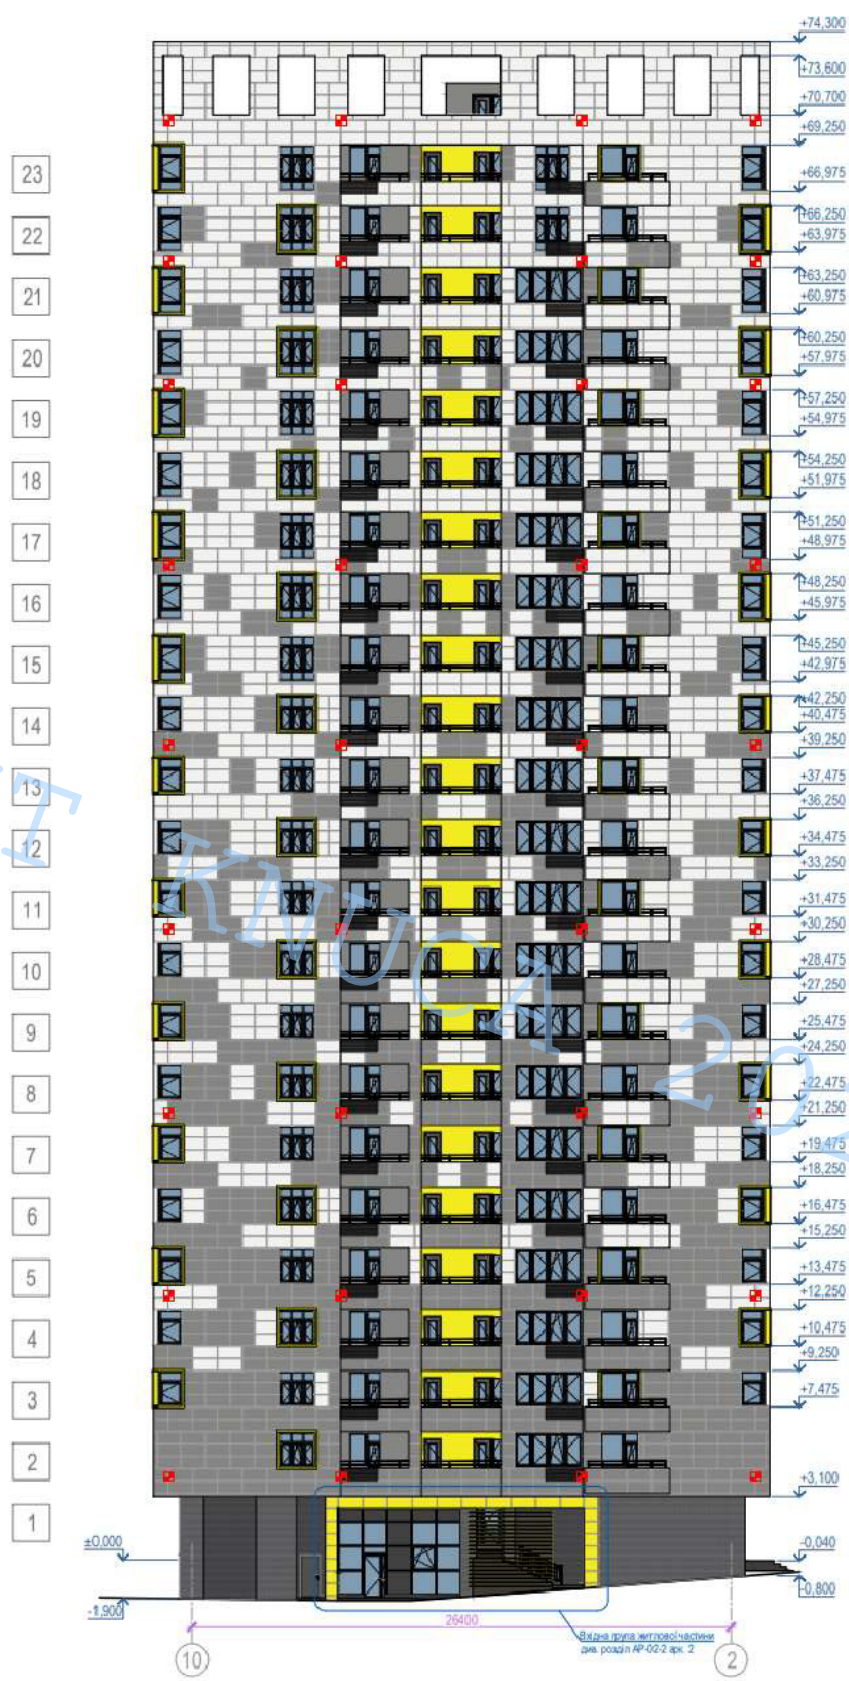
Проект закріплення марок та трипельпризм на фасаді будівлі по осях
